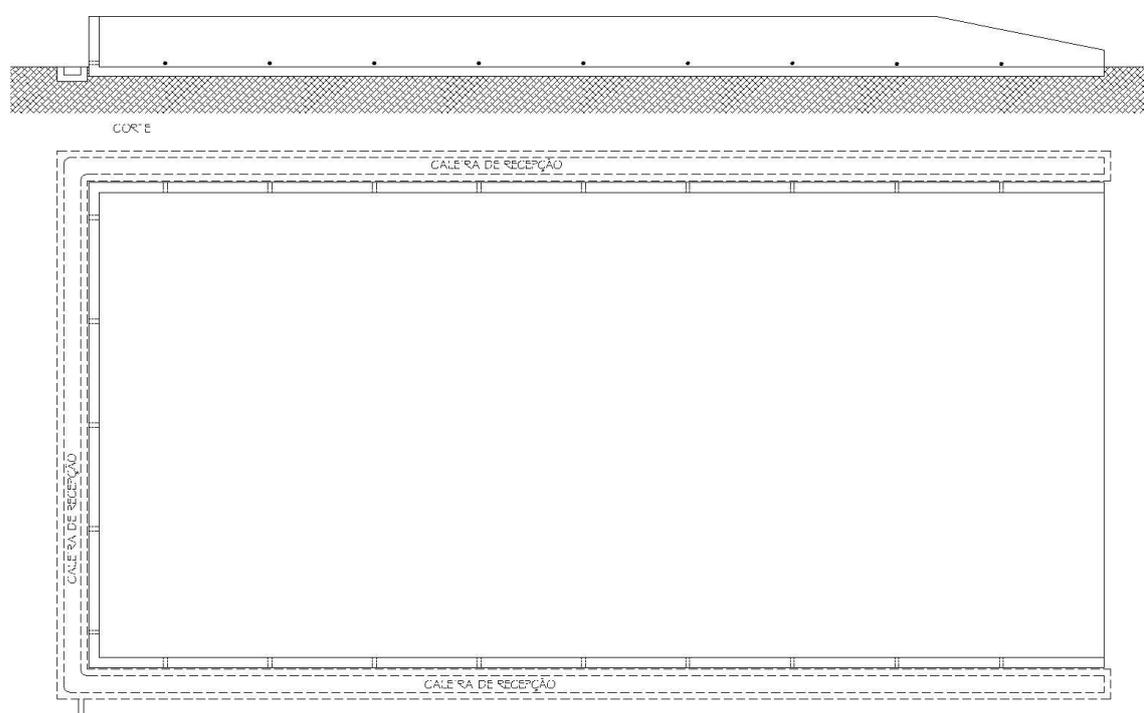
Planta da placa de estrume (armazenamento de efluente sólido).
